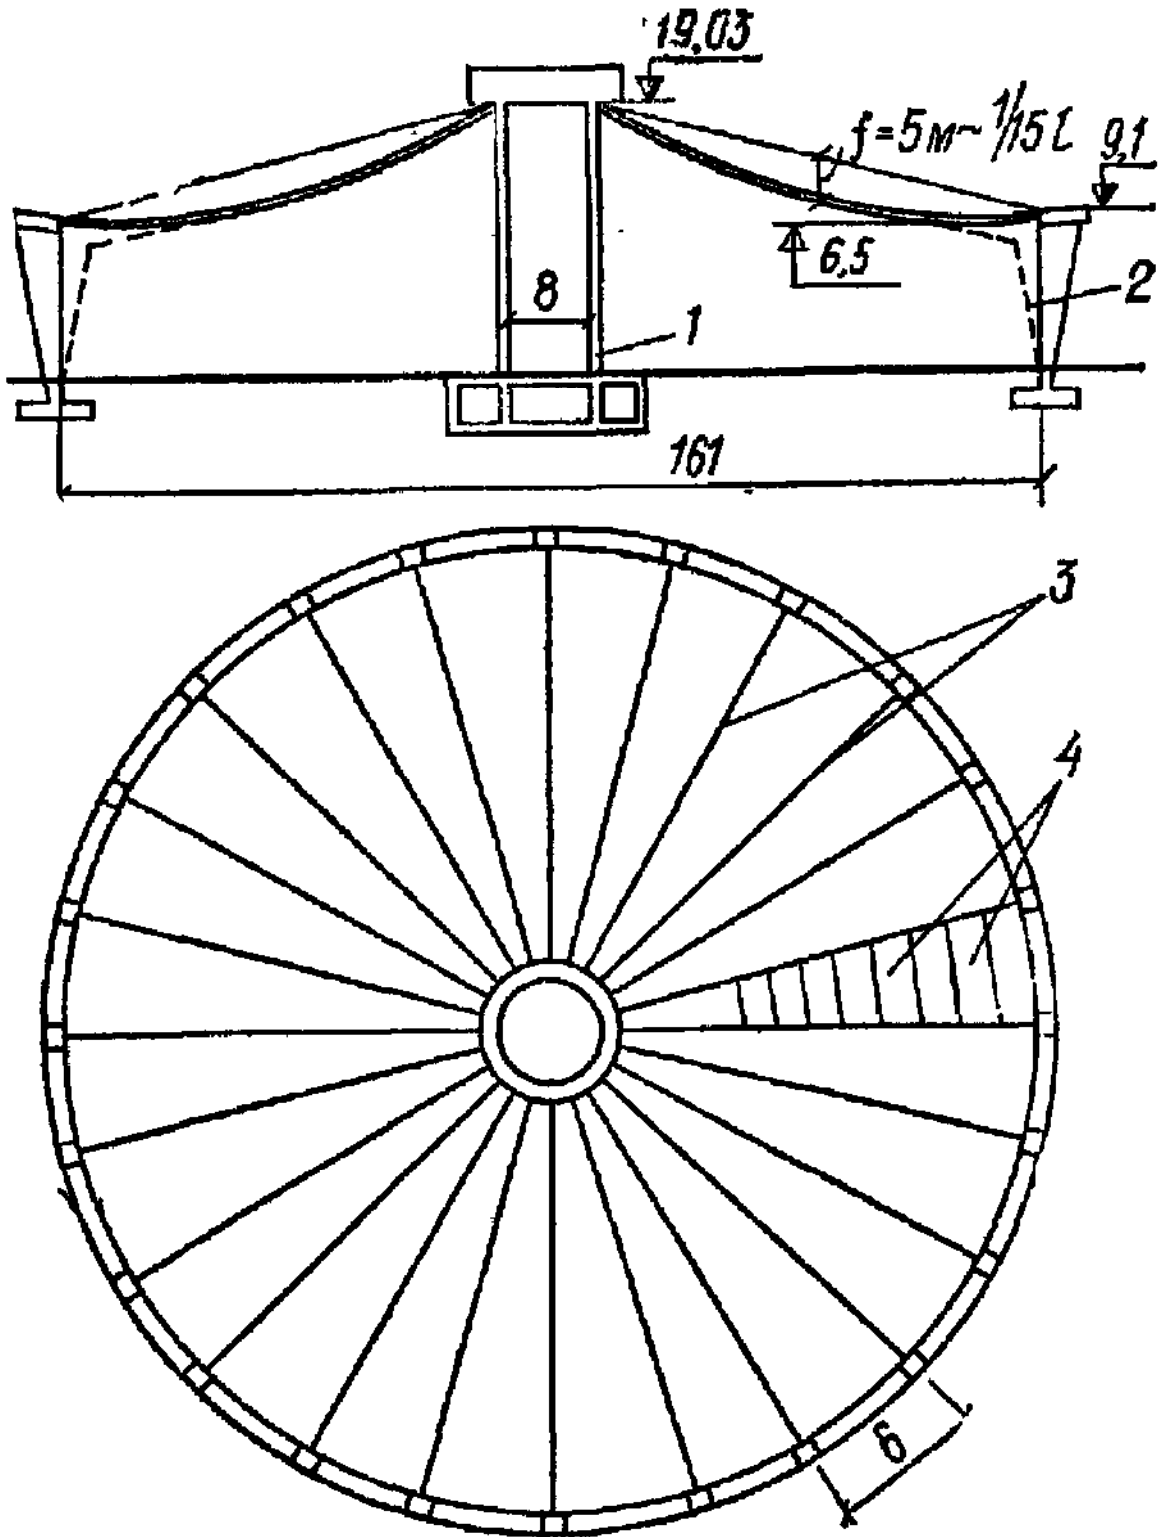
Покрытие гаража в Киеве: 1 – средняя железобетонная опора; 2 – водосток; 3 – тросы 84 шт. \times 65 мм; 4 – ребристые железобетонные плиты
